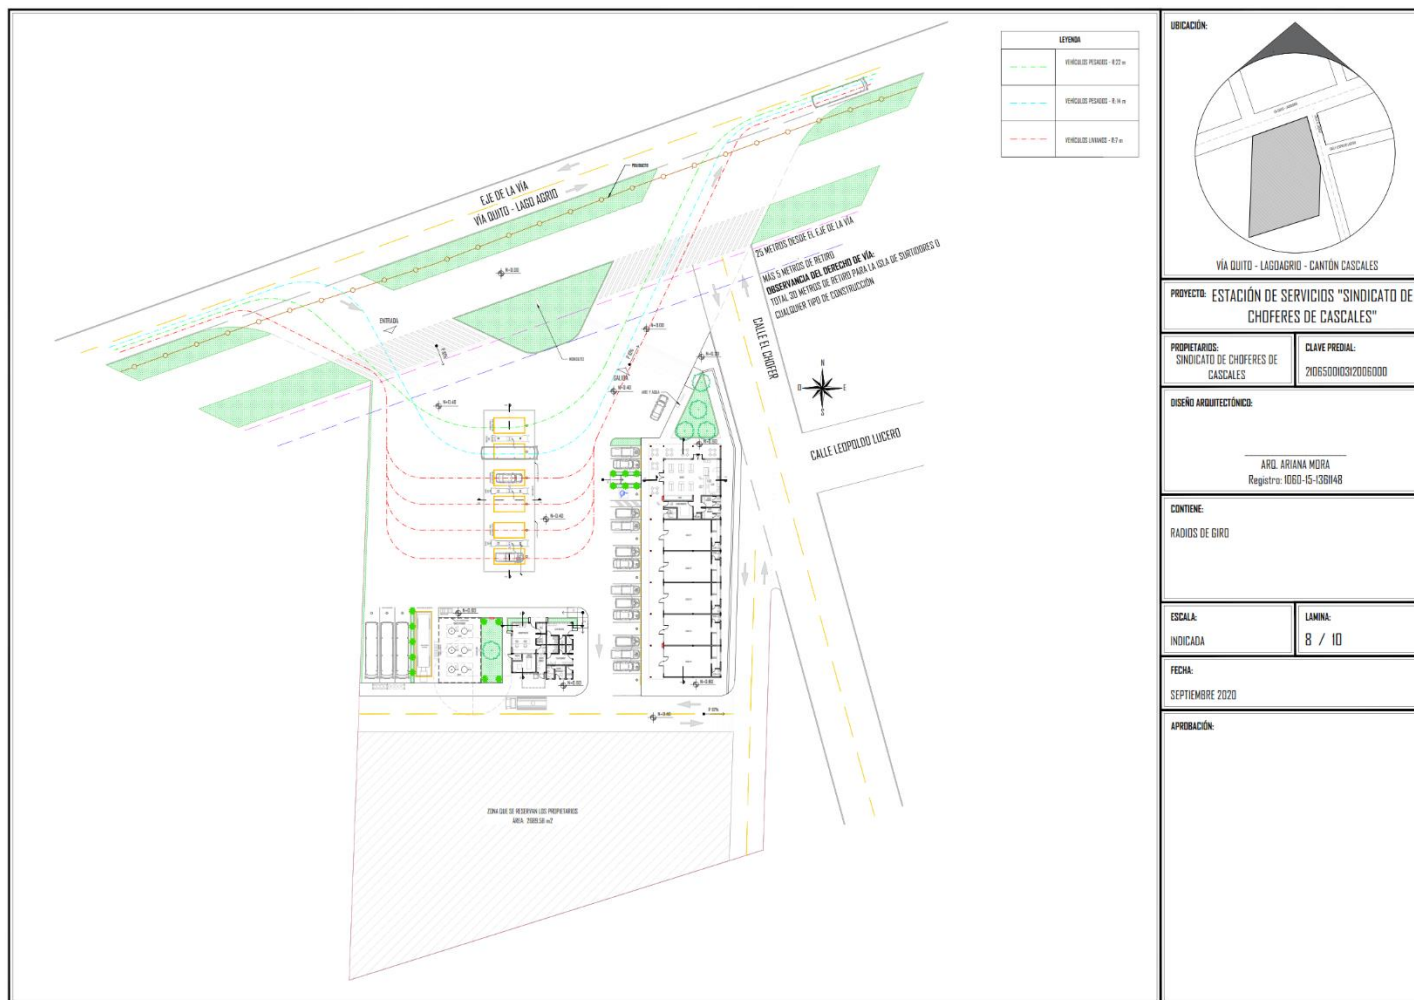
Plano georreferenciado de la construcción de la estación de servicio. Fuente: Plano arquitectónico
